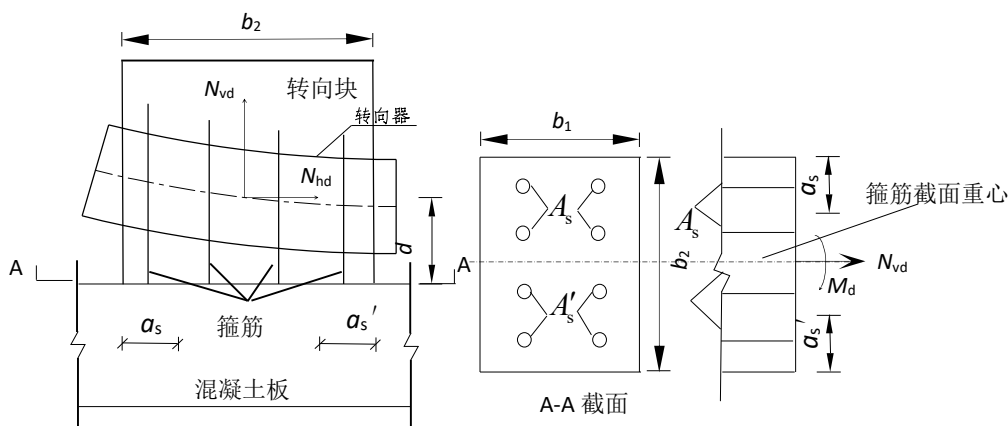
混凝土转向块抗拉承载力计算图式
